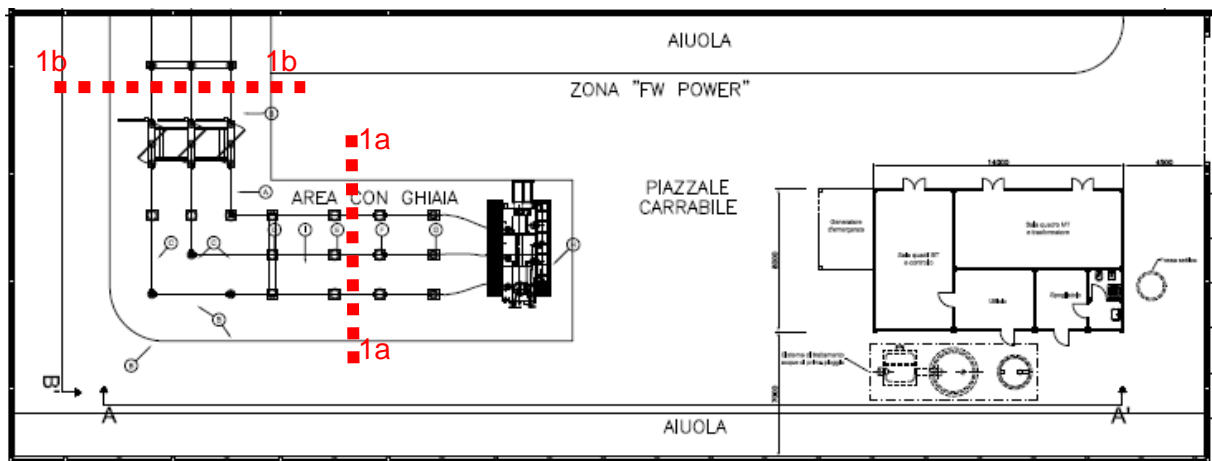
Planimetria della stazione 20/150kV – Sezioni 1a e 1b
